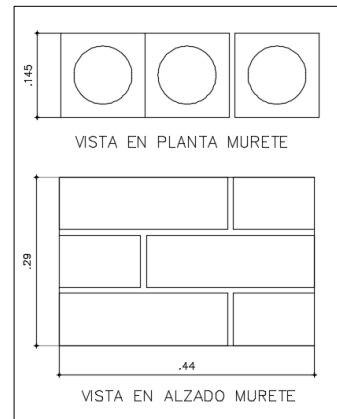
Muretes de mampostería sin inyección de grout de relleno. Fuente: el autor
